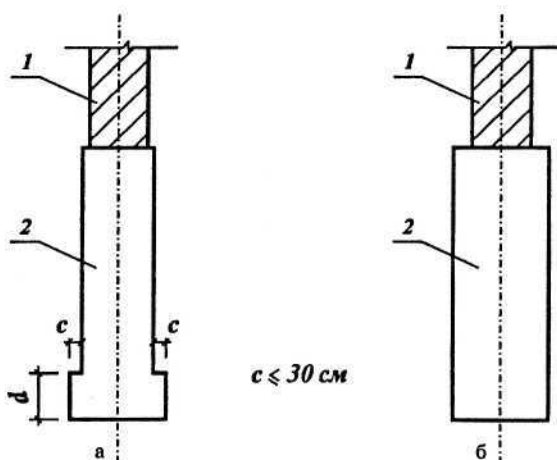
Сечение ленточного фундамента при незначительном отличии ширины подошвы фундамента от толщины стены:
